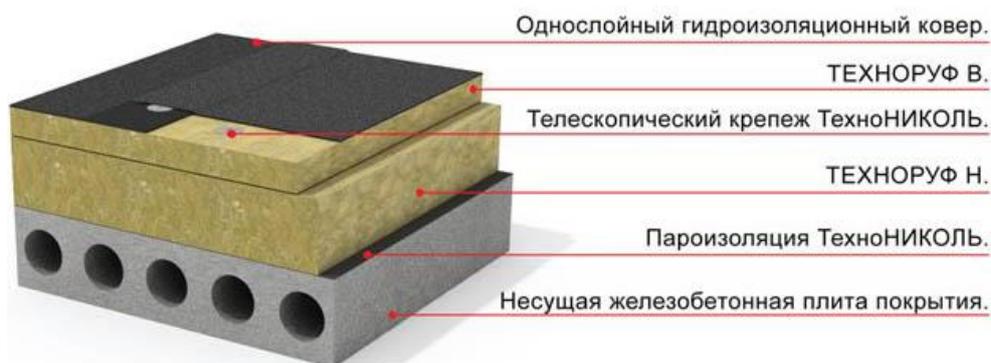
Двухслойное теплоизоляционное решение кровли с двухслойным наплавленным гидроизоляционным ковром и механическим креплением.
